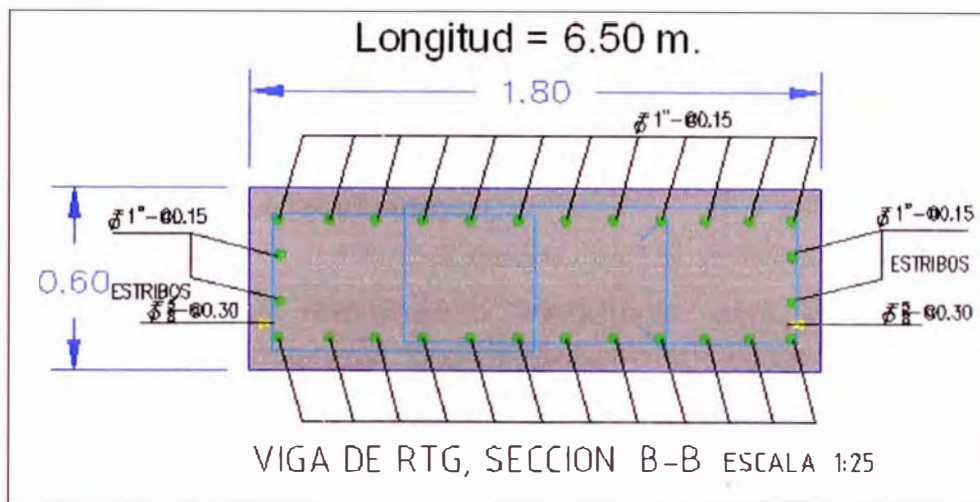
Dimensiones y cuantía de la viga RTG.
